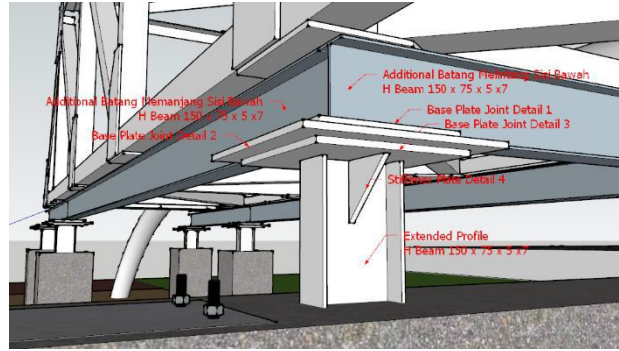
Pengelasan Extend Profile dengan Base plate Joint dan Stiffener plate
